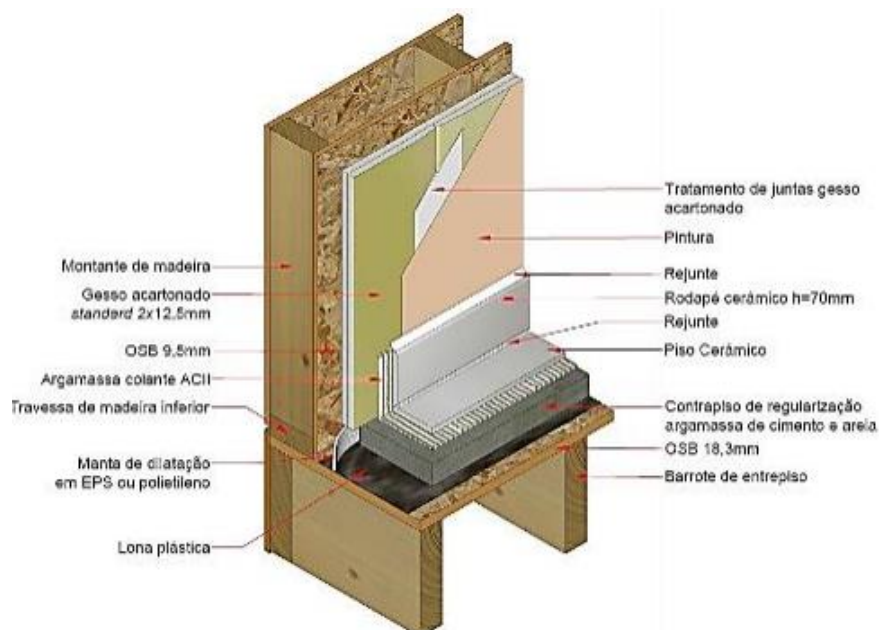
Pormenor da interface da parede externa e entrepiso – Áreas secas [27]
